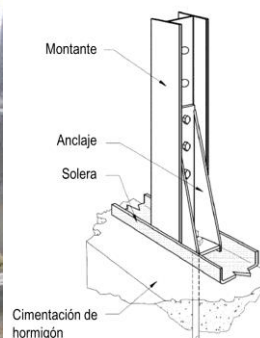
Detalles constructivos de edificio de dormitorios en California. (Allen, 2011).
